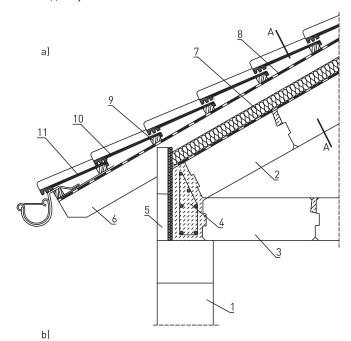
Опирание покрытия из кровельных плит YTONG с выдвинутыми плитами
